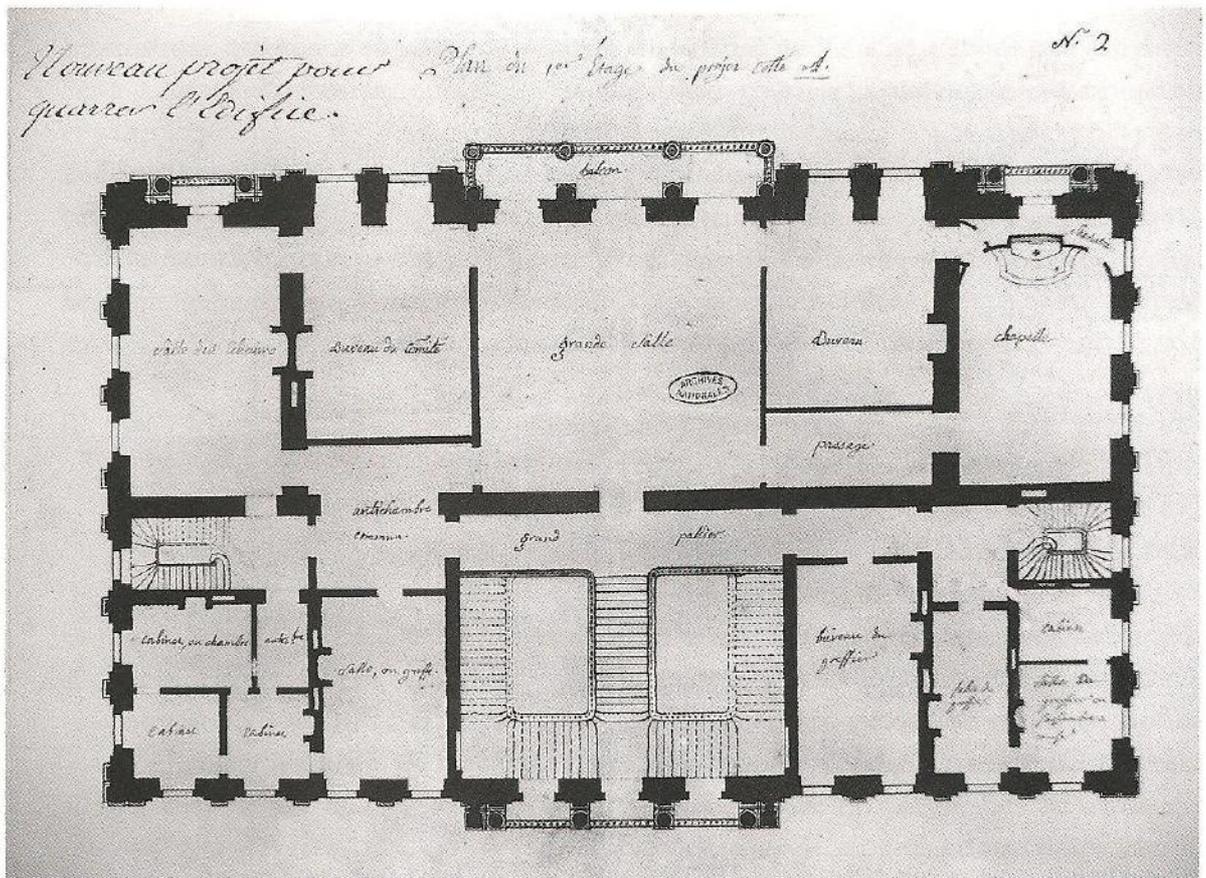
> Mansart de Sagonne : plan au premier étage du troisième projet avec double escalier central, 1748 [© AN, Cartes et plans].
